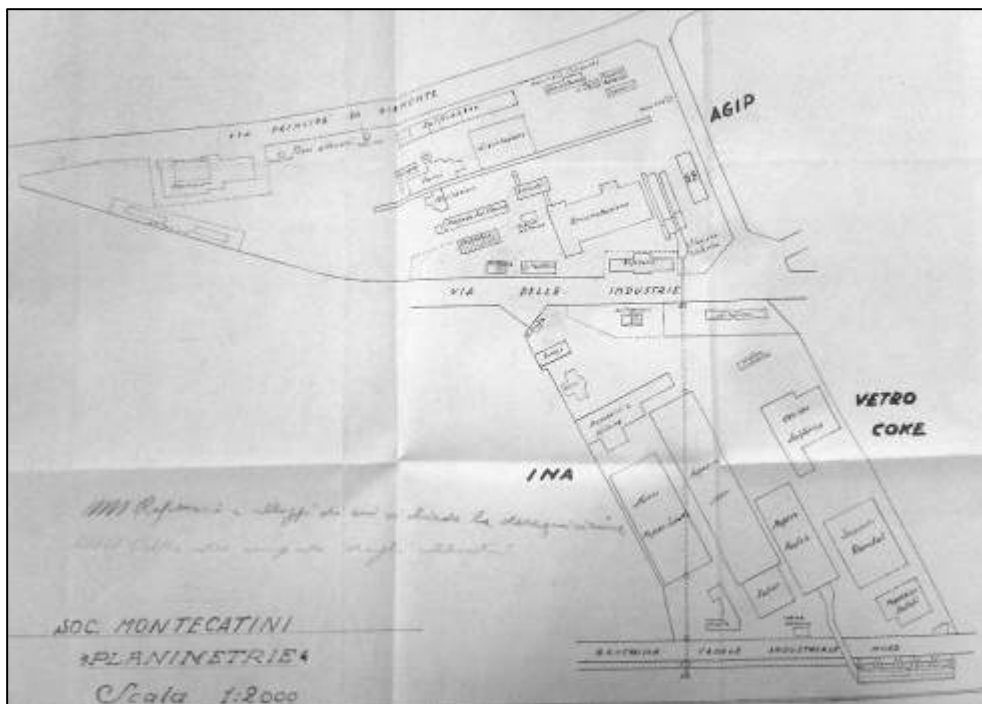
1946 ca, planimetria degli stabilimenti fertilizzanti e ceneri allegata alla richiesta di derequisizione degli edifici evidenziati⁴⁰ (fonte: archivio EZI)
